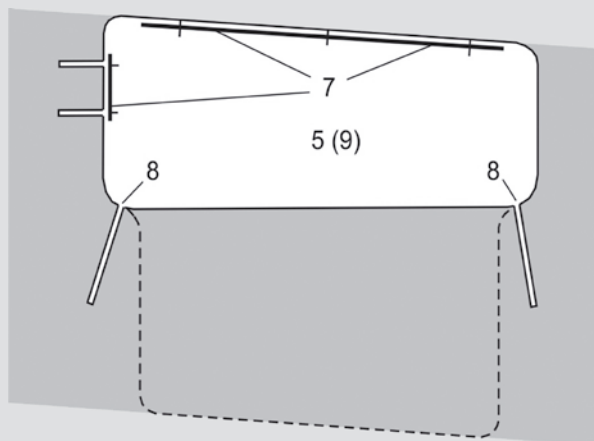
Поперечное сечение (А-А) выемочной камеры и заходки в слое у кровли пласта
